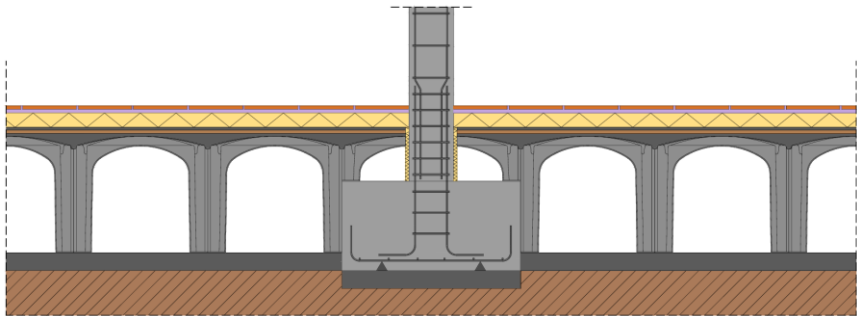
Detalle solera ventilada con pilar. 2024. Fuente: Propia
